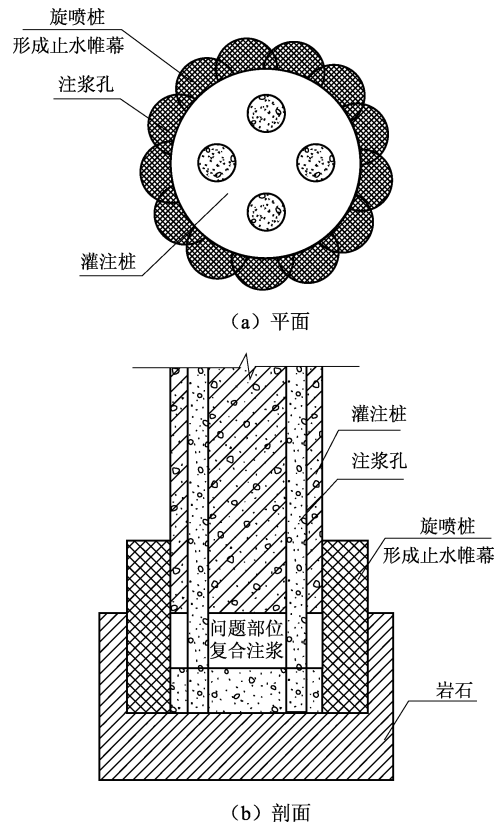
新型帷幕复合注浆法加固桩端平面及剖面图
